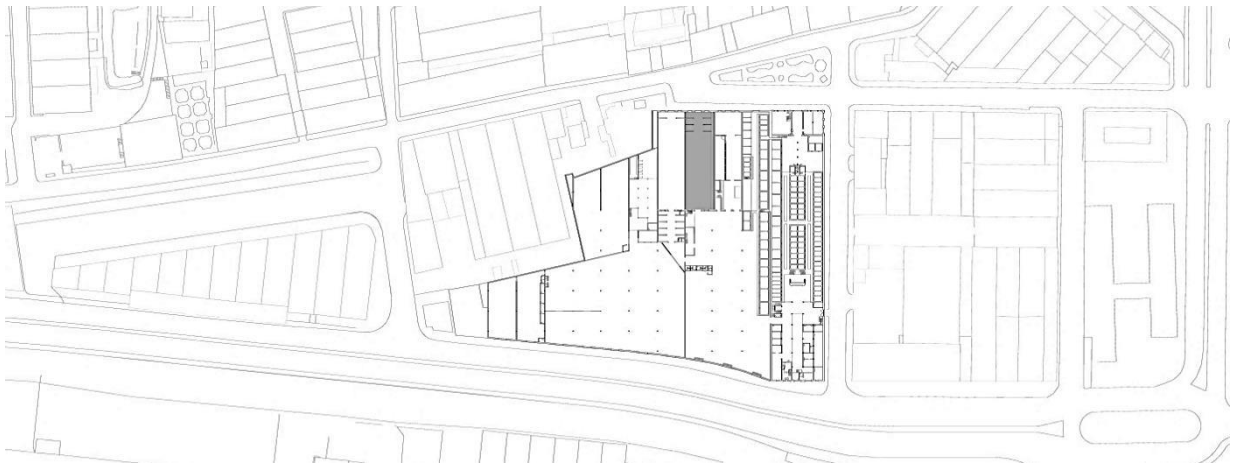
Planta de levantamento fotográfico piso térreo – Armazém 8.
